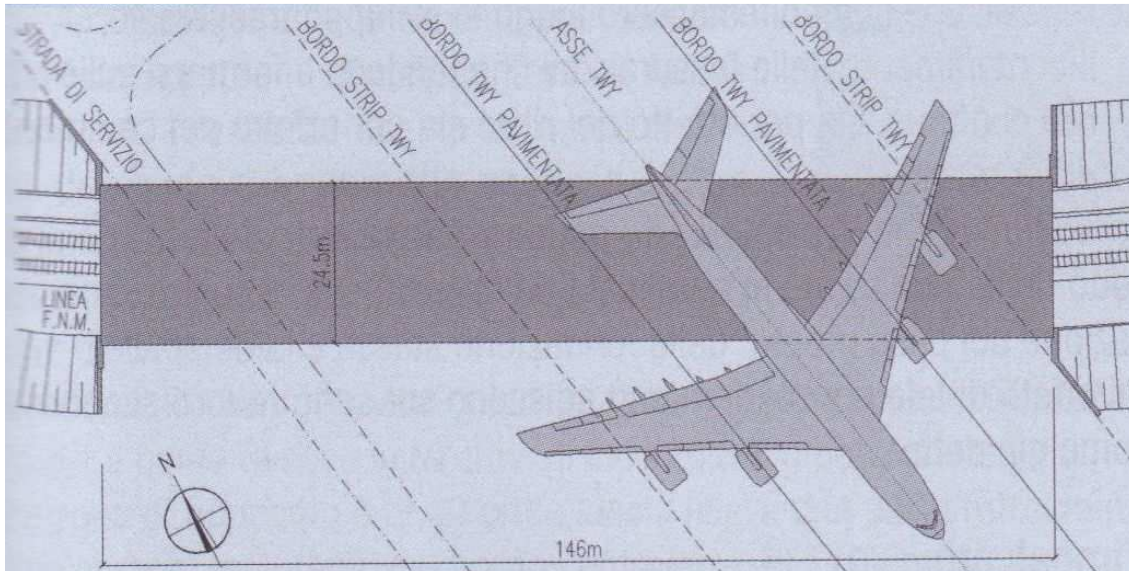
Planimetria del ponte Ovest (Comaita, Malerba, Paracchini, 2008)
